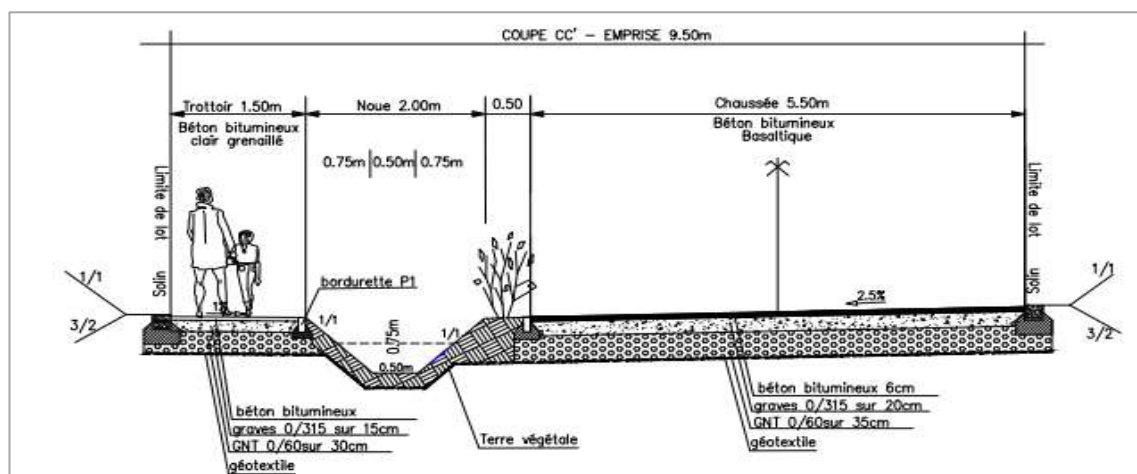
a : profil type de chaussée voie secondaire avec noue (Source : PA2, Geoval)
